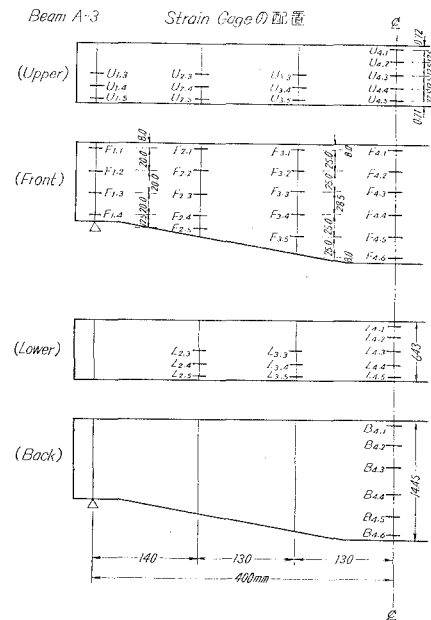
鋼箱桁模型 Beam A-3 のゲージの位置
